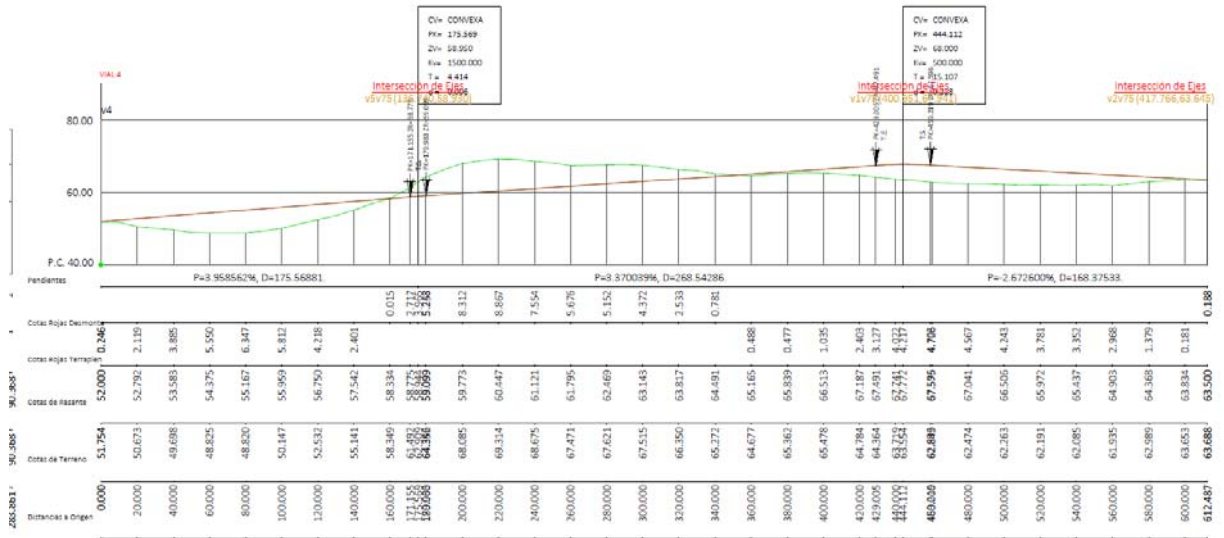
Imagen de la sección longitudinal del vial 4 en la alternativa 1.
